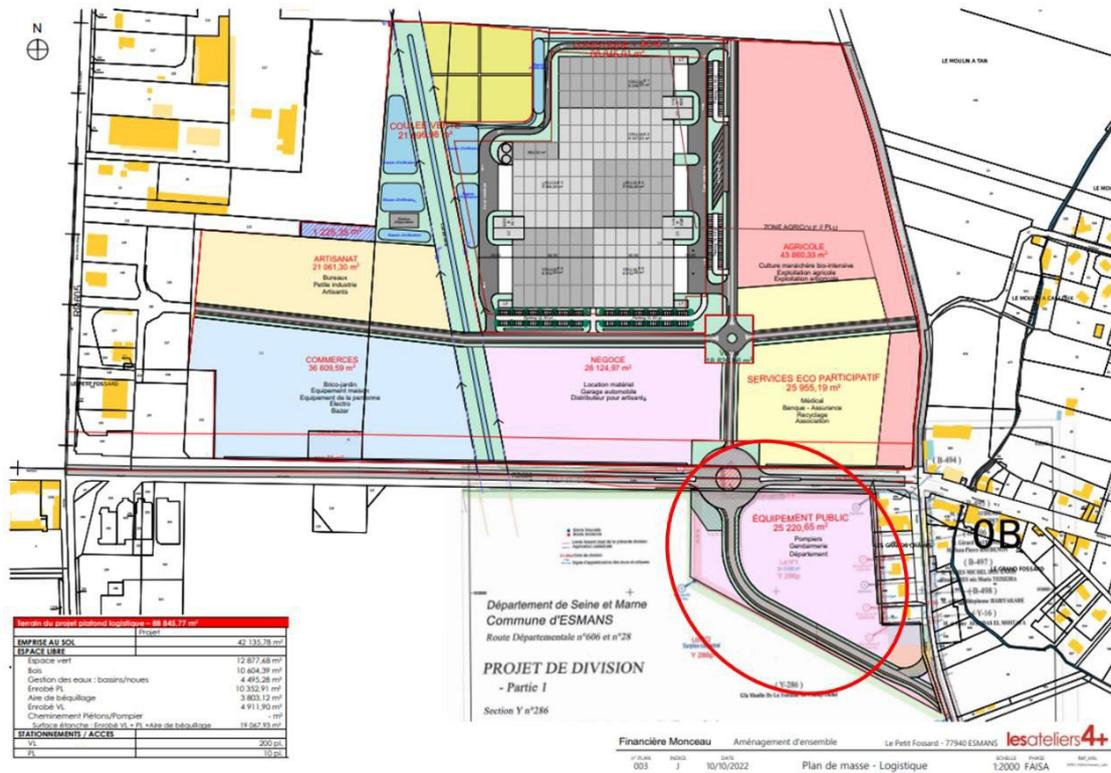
Présentation du projet sur fond de plan cadastral (source : lesateliers4+)
